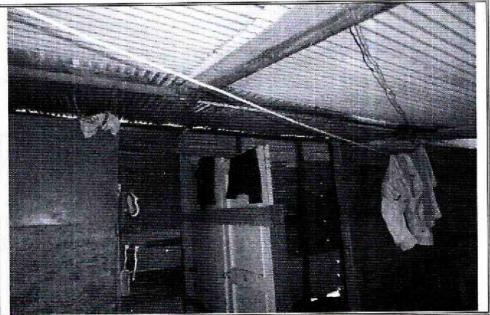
Sostenimiento de la cubierta con entramado en madera en la vivienda de la Calle 70 M Sur No. 19F-30.
